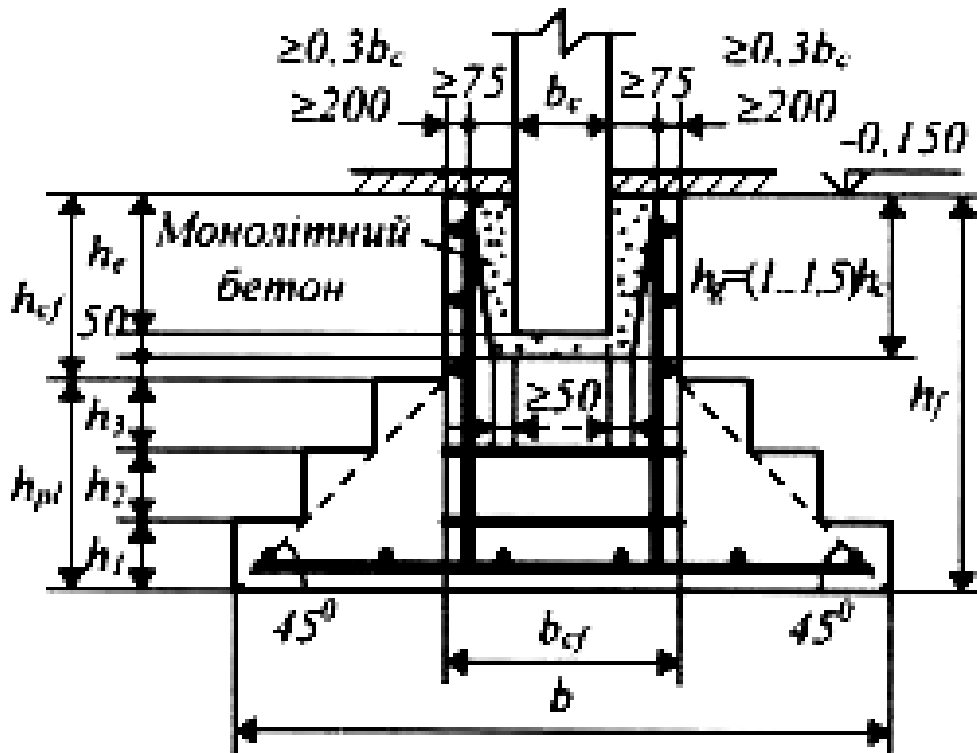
Монолітні залізобетонні фундаменти старанного типу:
